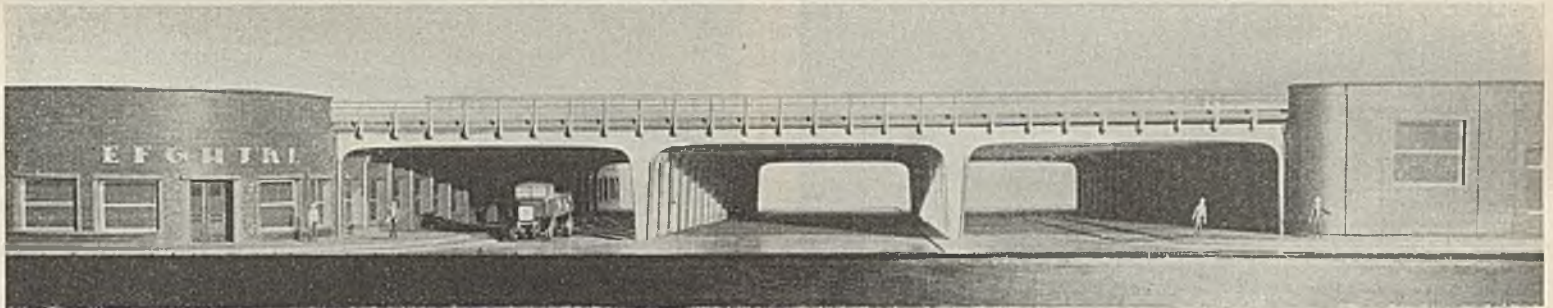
Unterführung der Kettwiger Straße in Essen.
